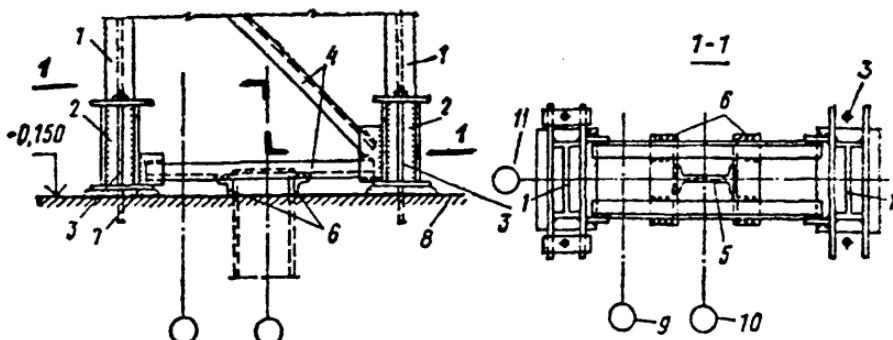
Узел опирания на фундамент стальной колонны одноэтажного производственного здания:
